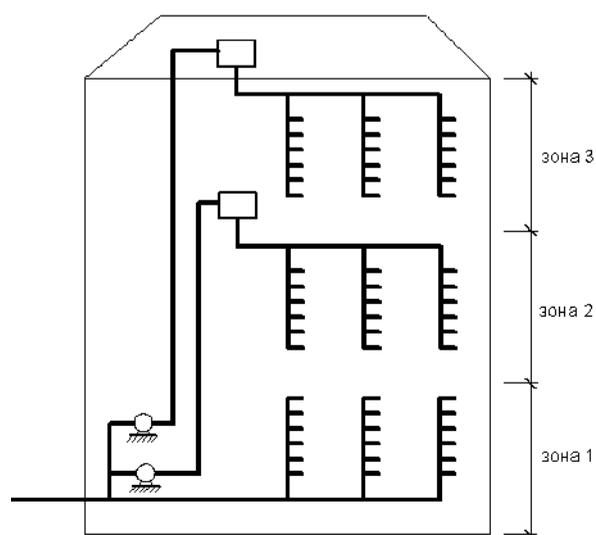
Схема водоснабжения здания с местной насосной установкой и гидропневматическим баком на чердаке
